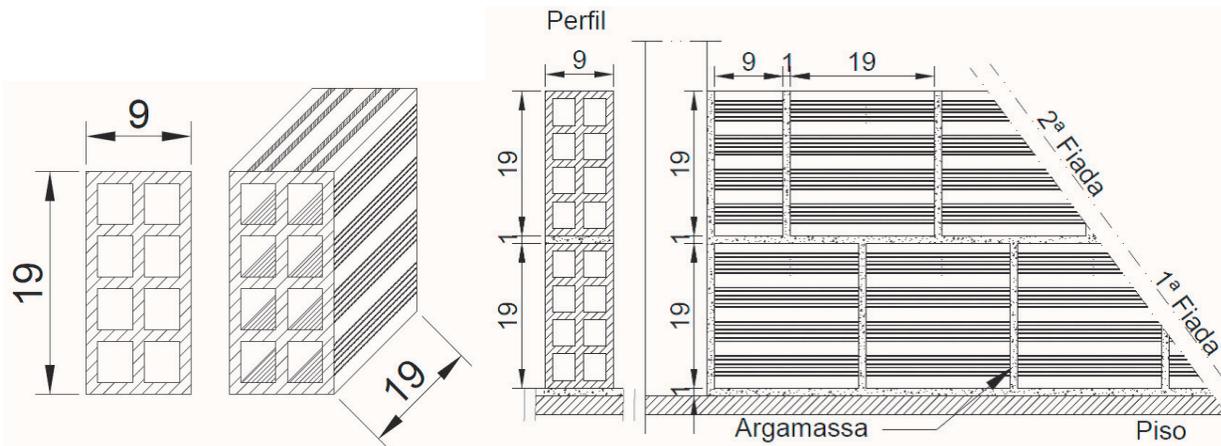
Tijolo cerâmico e montagem da parede de alvenaria
